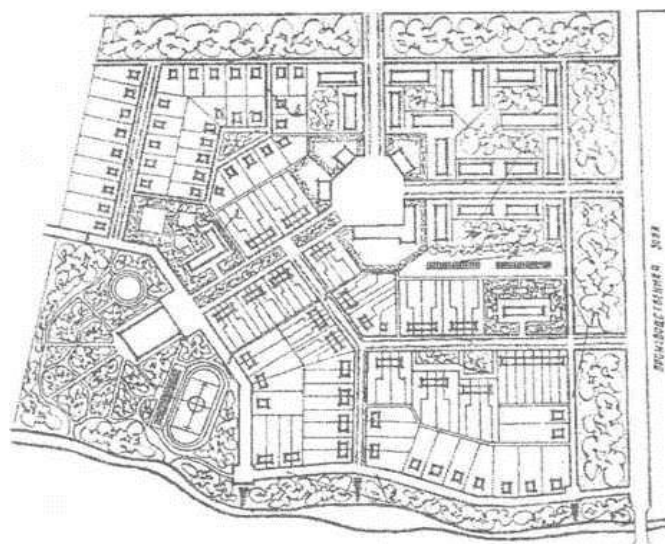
Вариант проекта планировки и застройки жилой зоны населенного пункта
